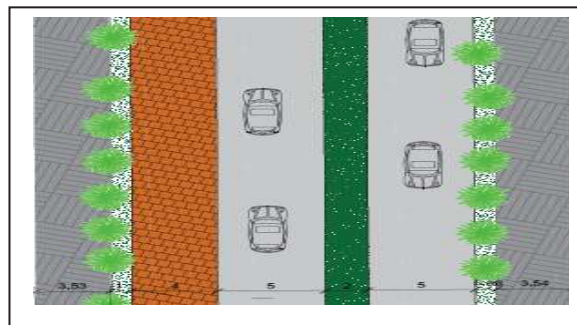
51 : vue en plan sur la rue Rochai.B
